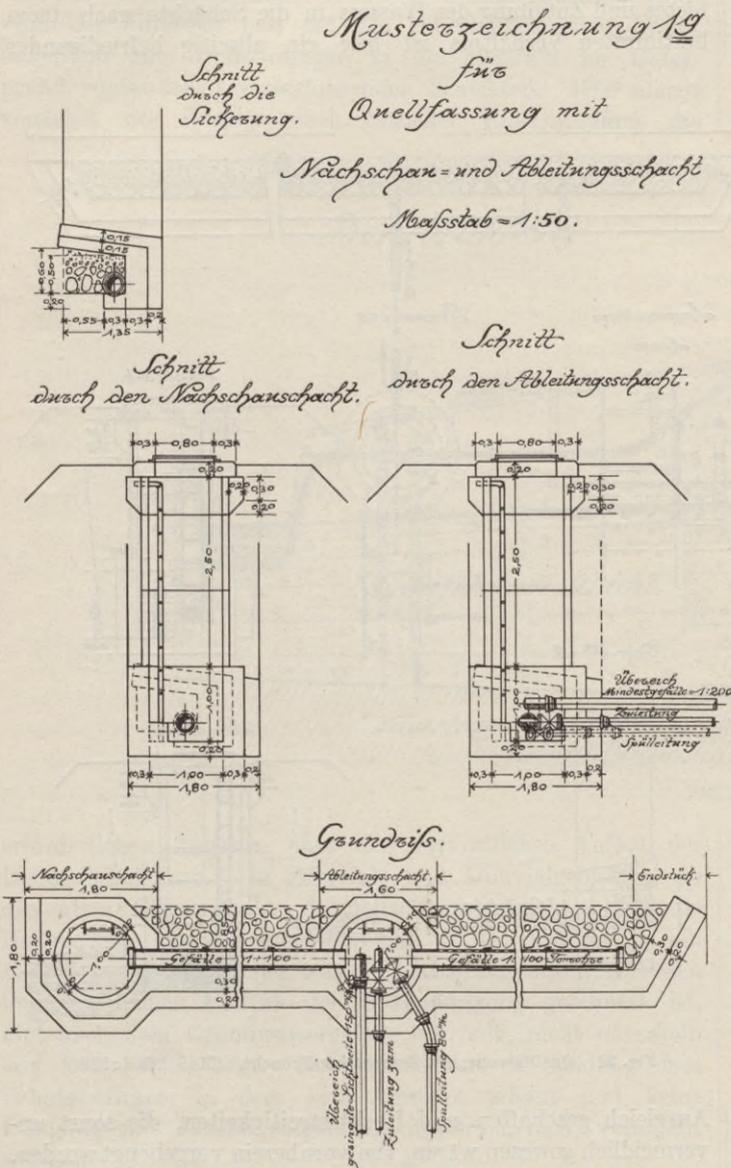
Quelfassung mit Nachschau- und Ableitungsschacht. (Maßstab 1:100.)
